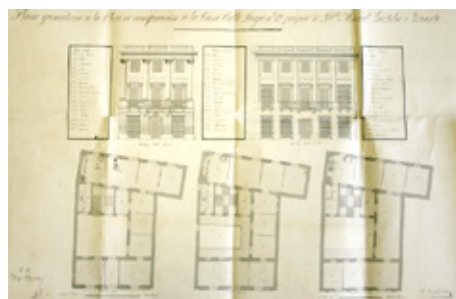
Planta y alzado de la casa de Manuel Gaztelu. AMEPSM.
